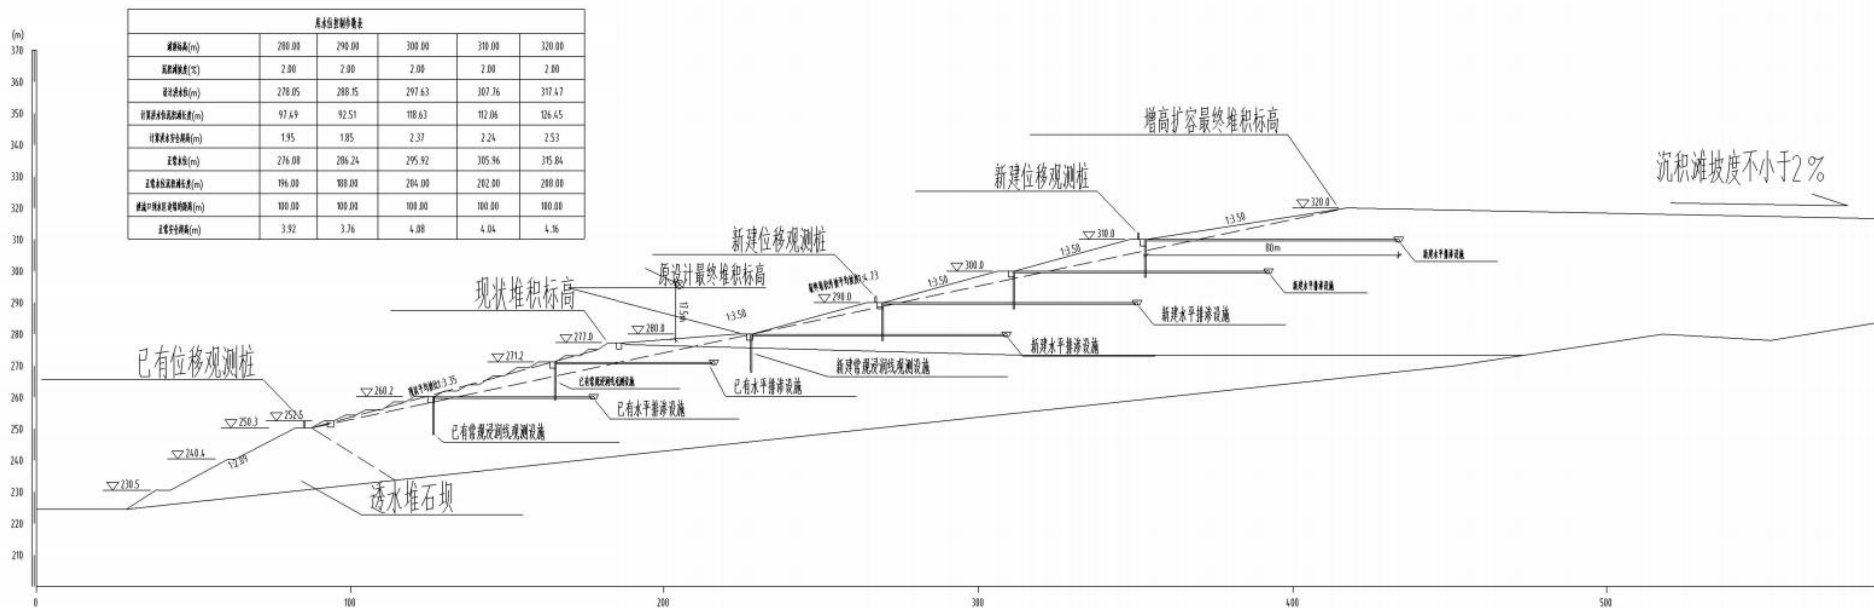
增高扩容尾矿坝坝体结构剖面图
